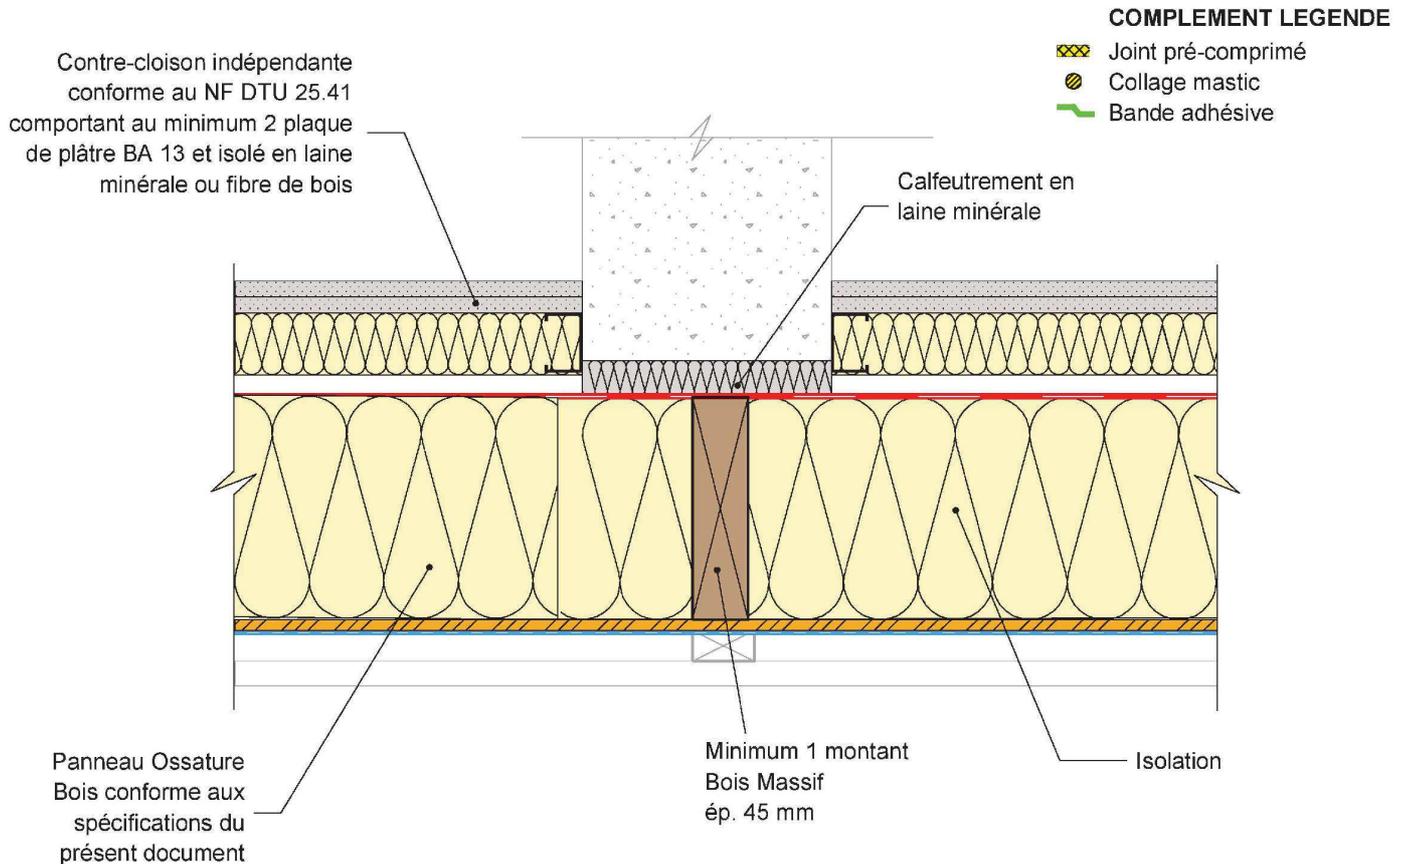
Coupe horizontale d'une liaison refend / façade filante
